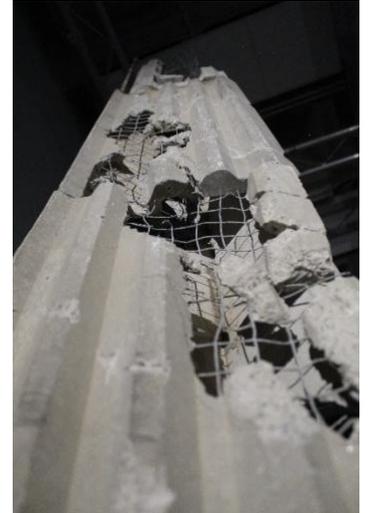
Detalle de una de las esculturas, imagen 3. Foto del autor.
